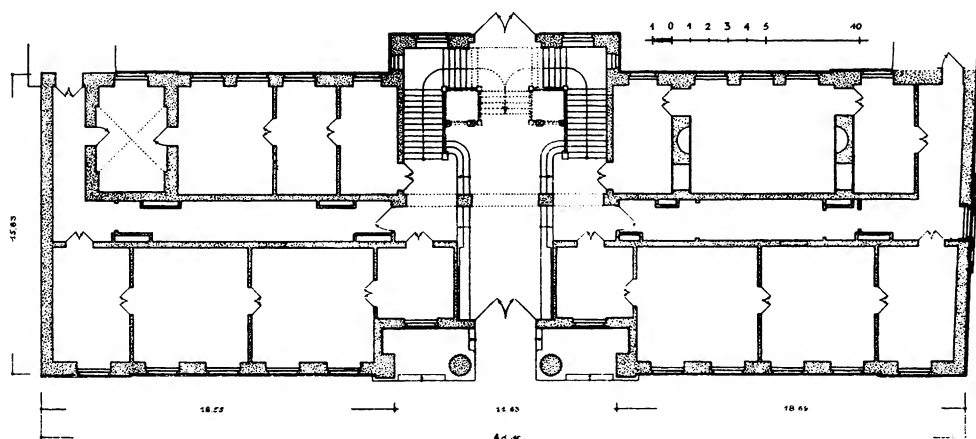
Anhaltische Gemäldegalerie. Grundriß (Maßstab 1:400)
